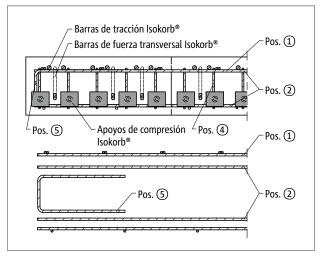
Schöck Isokorb® XT tipo K-M11: Armadura in situ del lado del balcón en la sección A-A; pos. 4 = refuerzo constructivo en el borde libre
